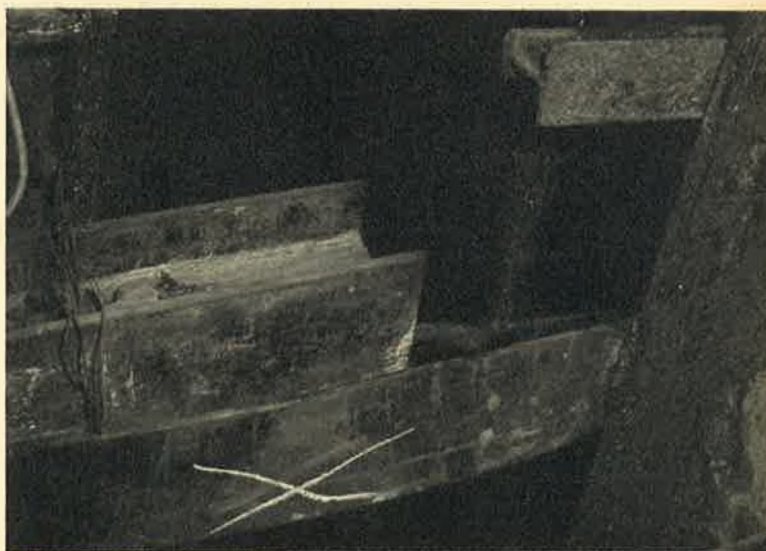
ligger van 12 cm hoogte voor het stutten van de « liner-plates », volledig vervormd onder de druk van de grond.
